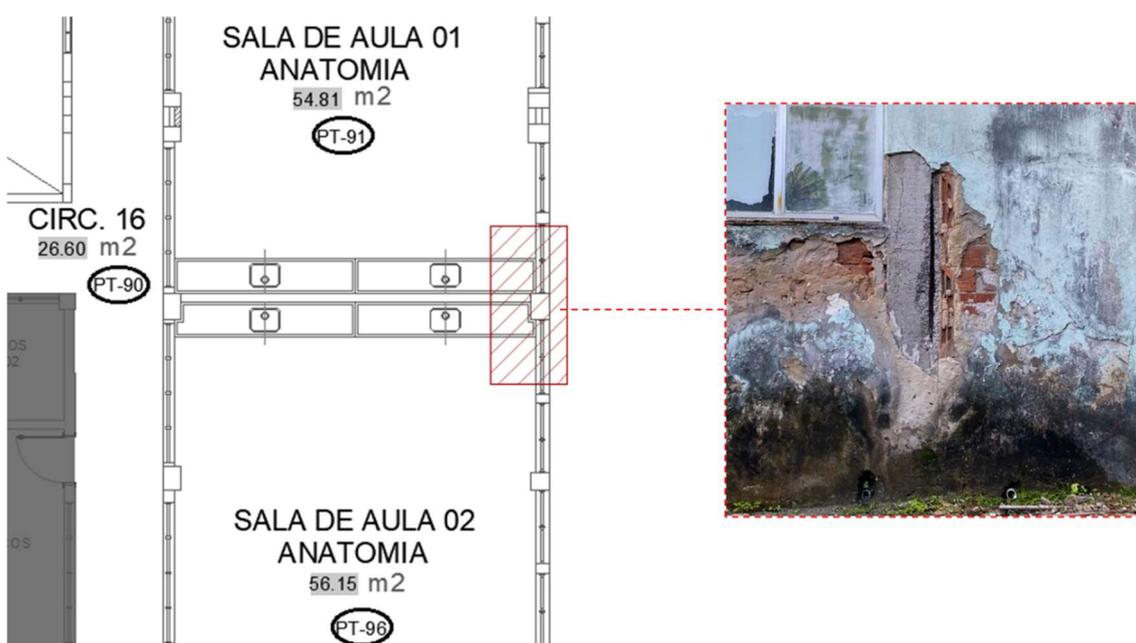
Plata Baixa do Primeiro Pavimento – Corredor de Circulação;
